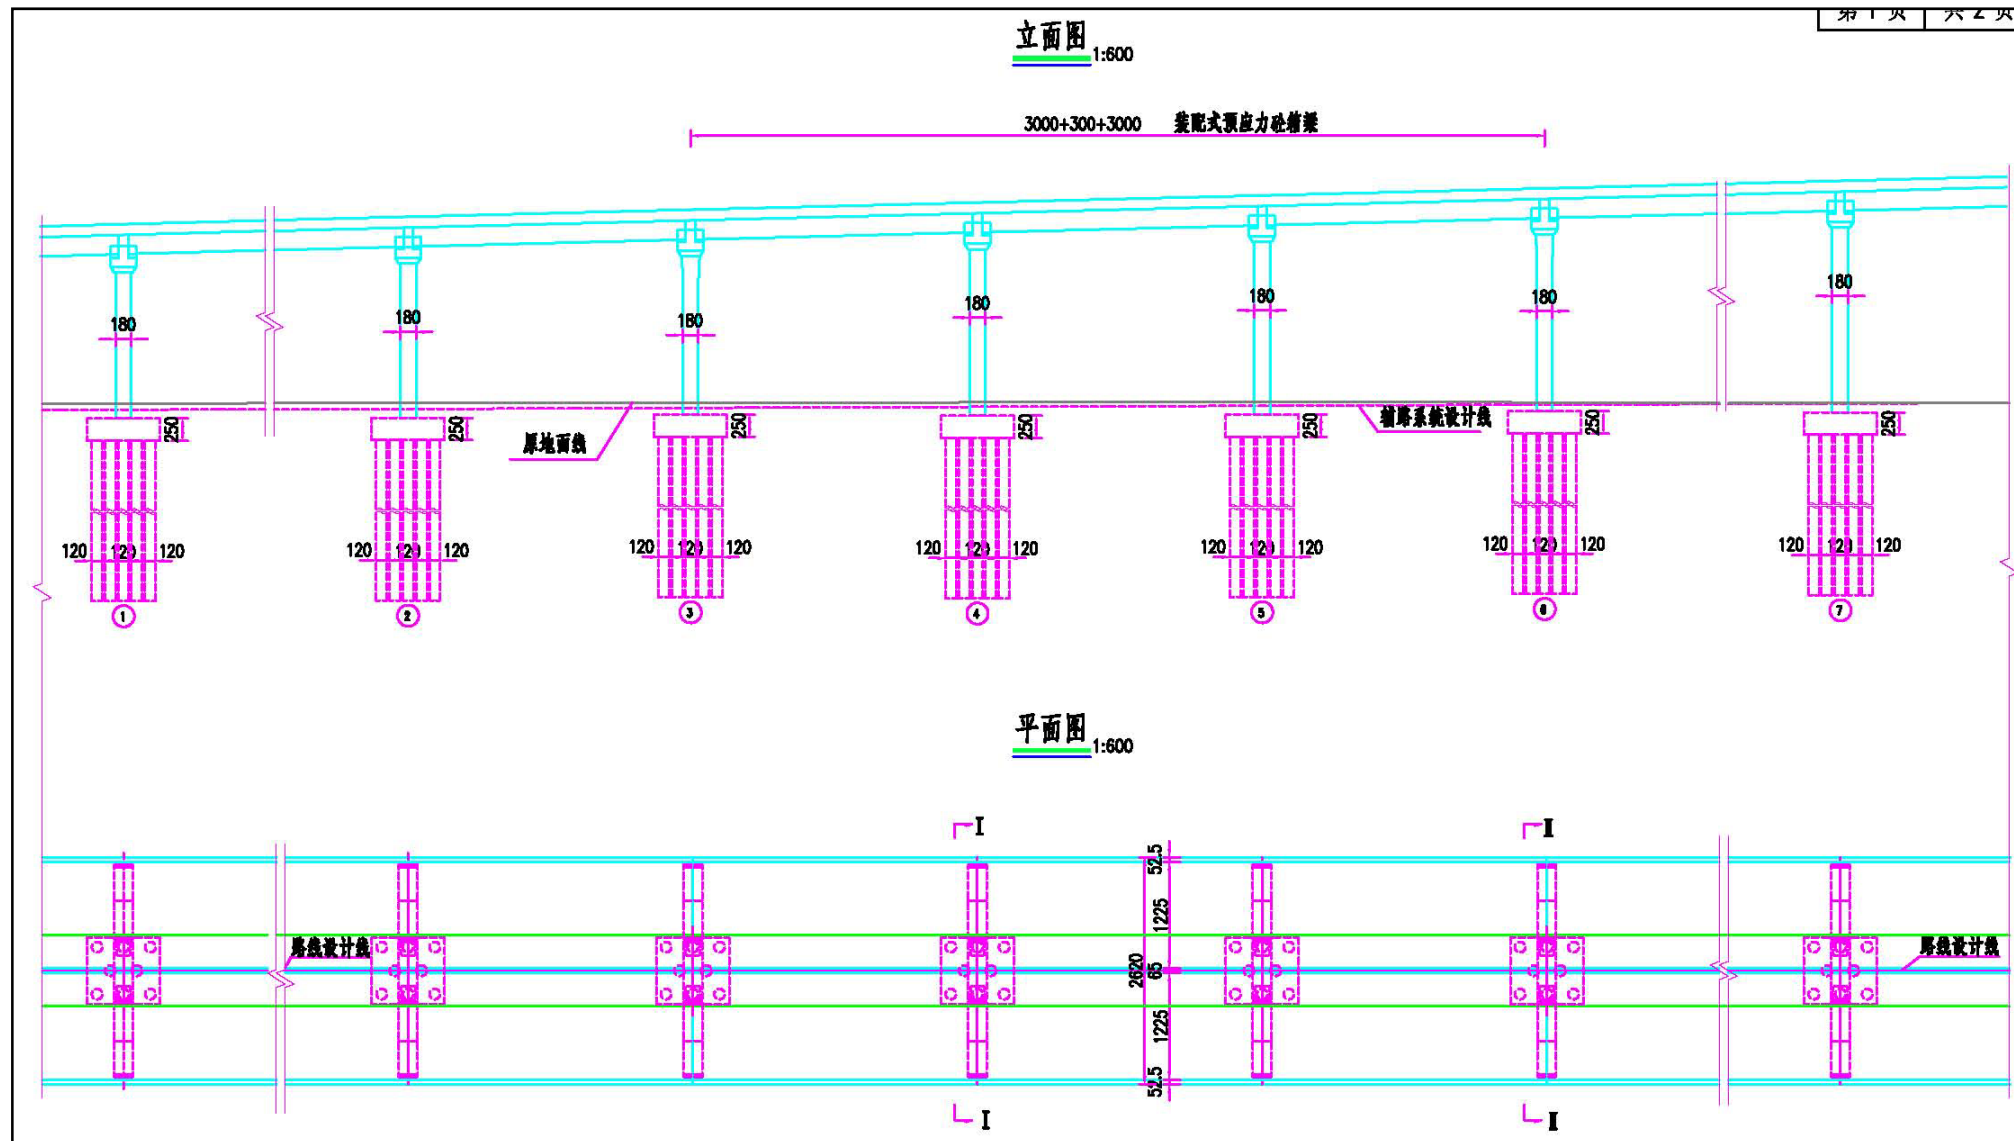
主线高架桥桥型平面布置图（含立面、横断剖面）
